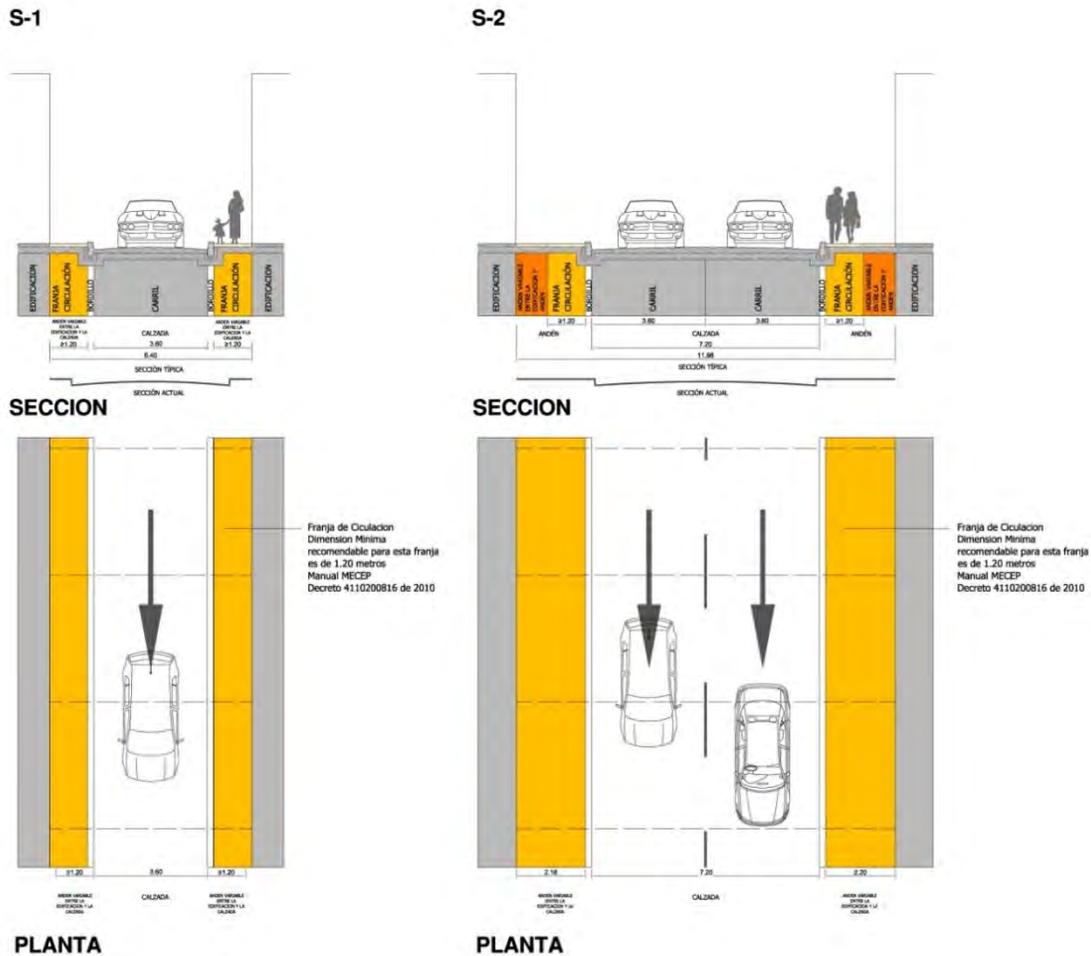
Sección Transversal de vías locales del Centro Histórico de Santiago de Cali
